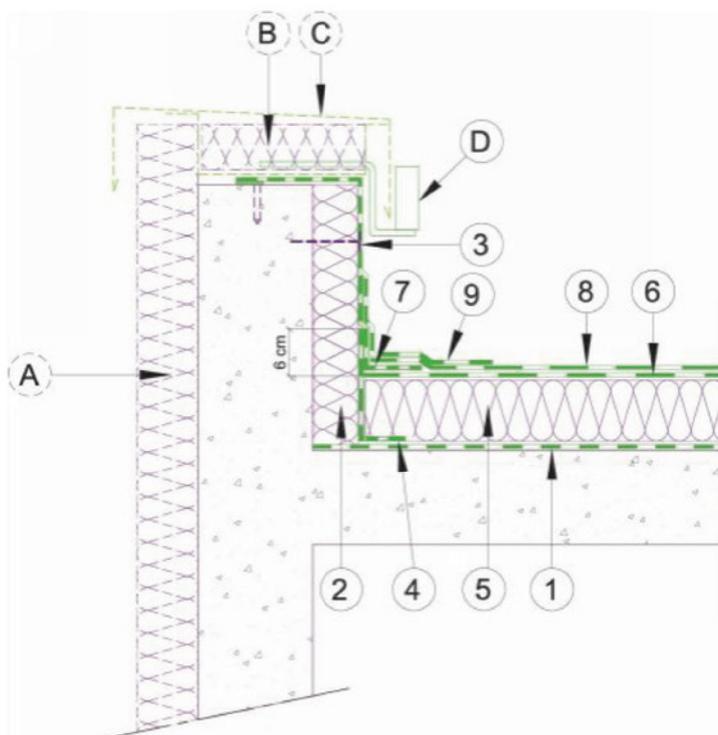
Relevé d'étanchéité sur isolant apte à recevoir un revêtement bitumineux soudé (laine minérale et perlite) apparent
